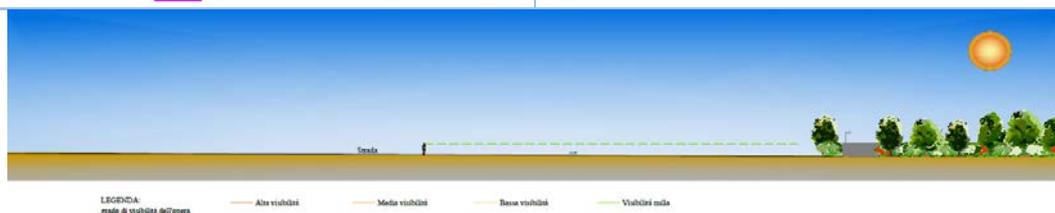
Sezione di intervisibilità dal punto di vista chiave n. 1 dalla strada del Piano Particolareggiato dell'“AIA” verso l'area dell'impianto
